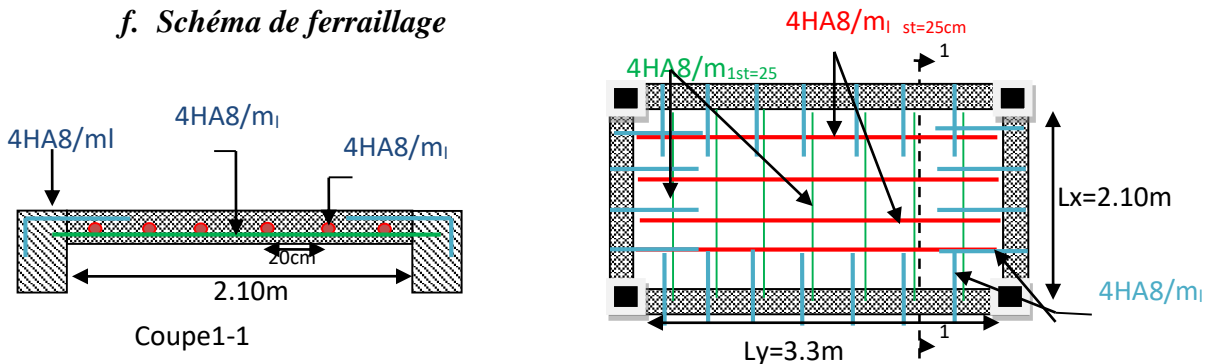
Schéma de ferrailage de la dalle poste transformée.
